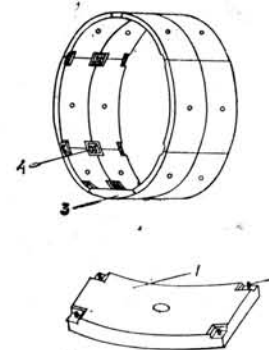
Конструкция обделки перегонного тоннеля закрытого способа работ из усовершенствованных элементов:
